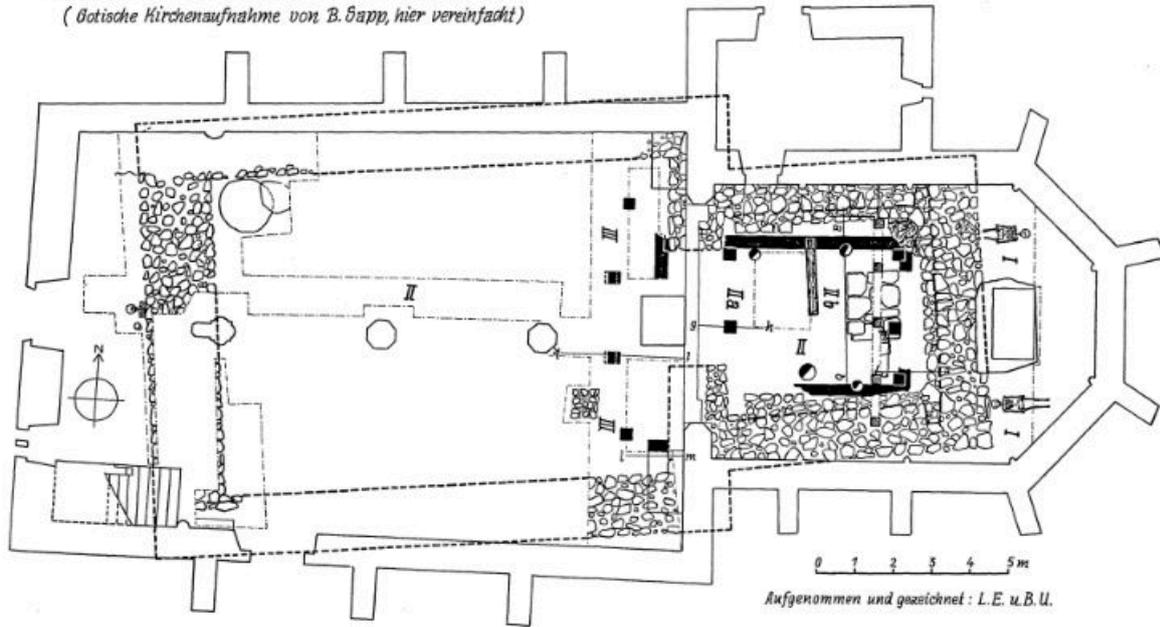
Eduard Beninger und Benno Ulm: Kirche St. Michael bei Oberrauhenödt, Grabungsplan Grundriss, 1958.
